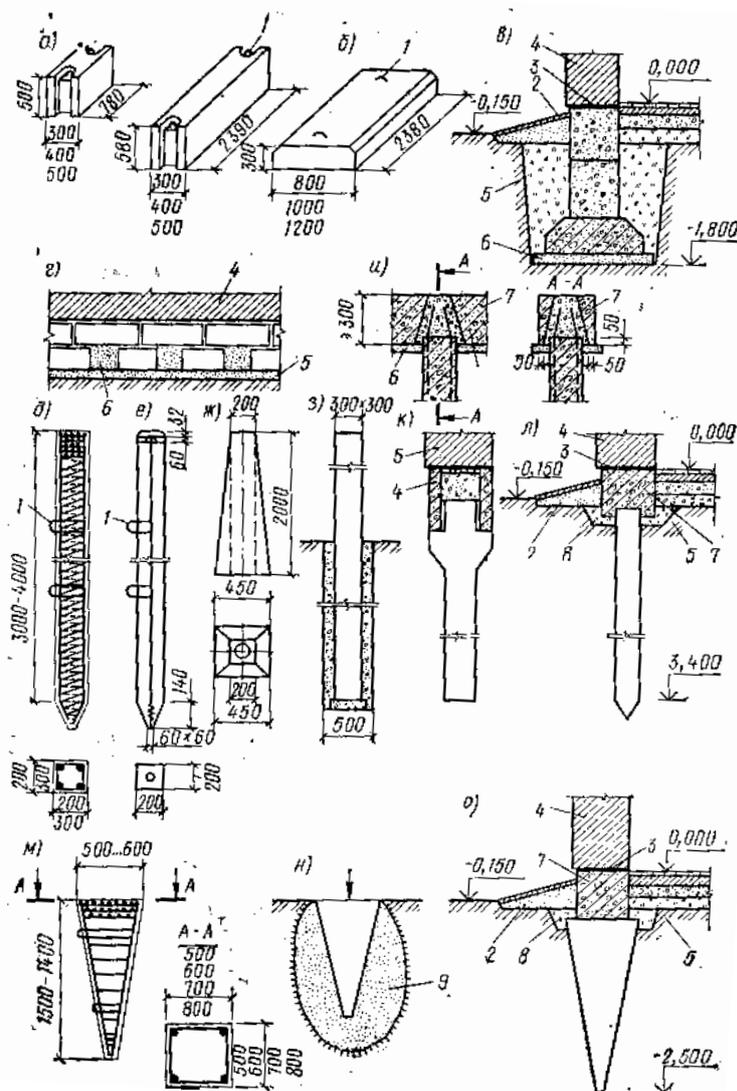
Конструкции сборных ленточных и свайных фундаментов: а – стеновые фундаментные блоки; б – фундаментная плита-подушка; в – разрез ленточного фундамента; г – прерывистые фундаменты; д – призматические сваи; е – забивная предварительно-напряженная свая; ж – забивной пирамидальный блок; з – свая-мачта; и – узлы сопряжения сборного ростверка с призматическими сваями; к – фундаменты на сваях с колоннами; л – конструктивное решение фундаментов на призматических сваях с консолями; м – конструктивное решение фундаментов на призматических сваях; н – короткая пирамидальная свая; о – схема совместной работы пирамидальной сваи с грунтом; п – конструкции фундамента на коротких пирамидальных сваях; 1 – монтажные петли; 2 – отмостка; 3 – гидроизоляция; 4 – стена; 5 – грунт; 6 – песок; 7 – ростверк; 8 – засыпка песком или шлаком; 9 – уплотненного грунта.
